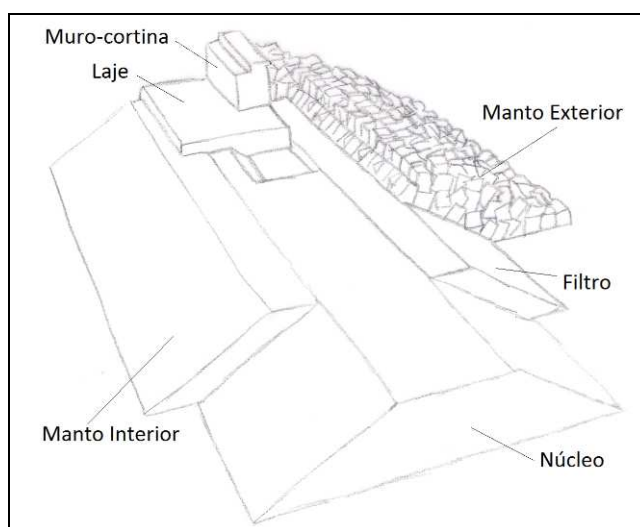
Esquema construtivo de um quebramar misto.
